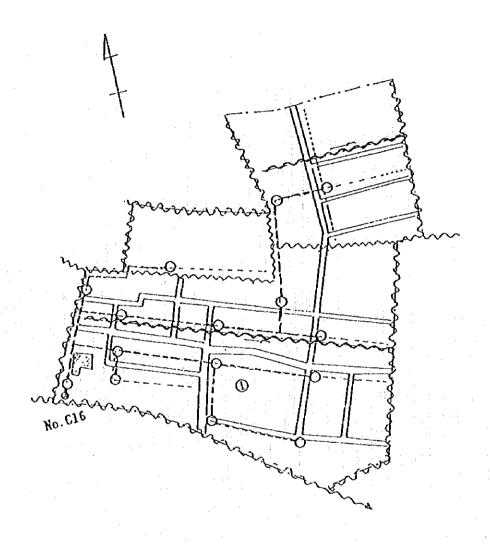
Plan horizontal du projet des installations terminales (Draa Sud)
